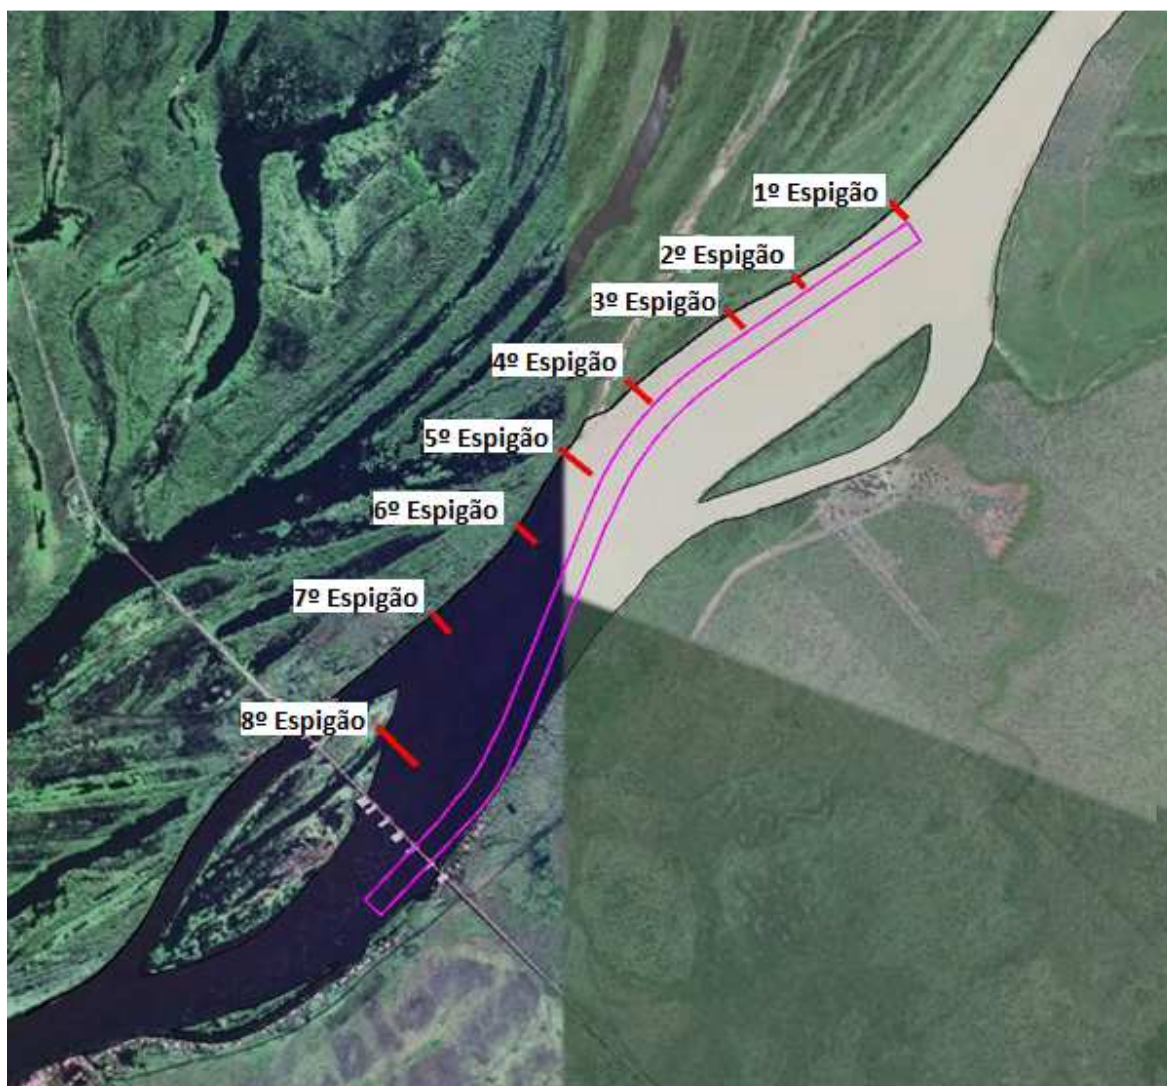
Croqui da localização da 2ª configuração de espigões ao longo da área de estudo.
